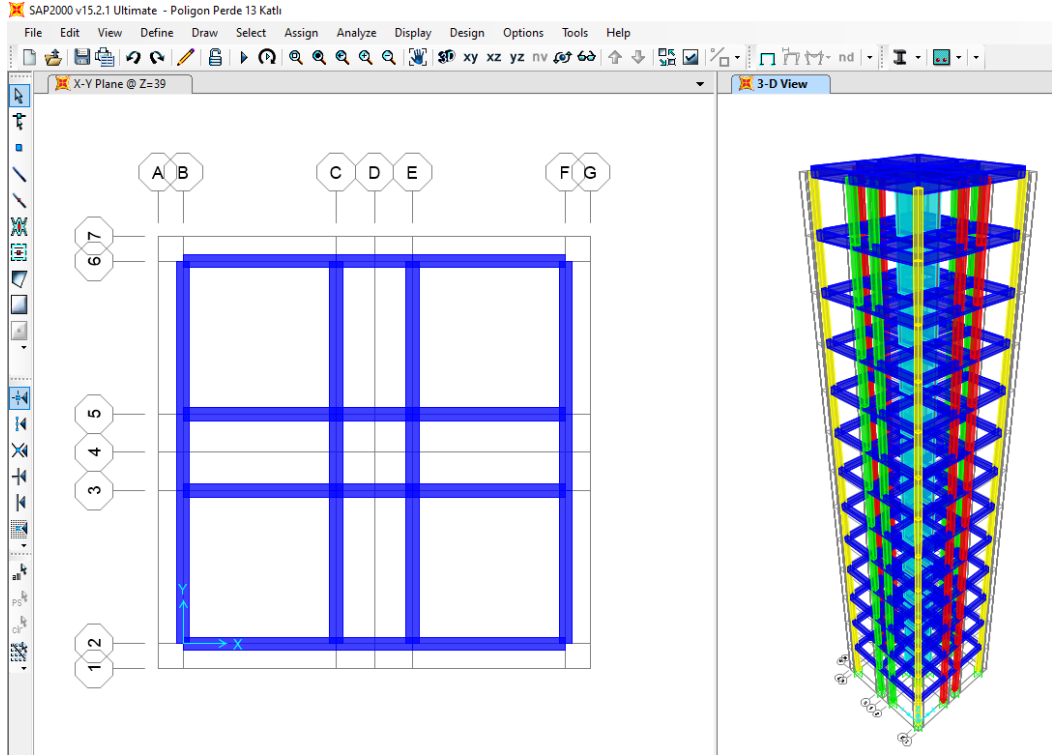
PP_DB1 modelinin 13 katlı yapısının planı ve dış görünümü
